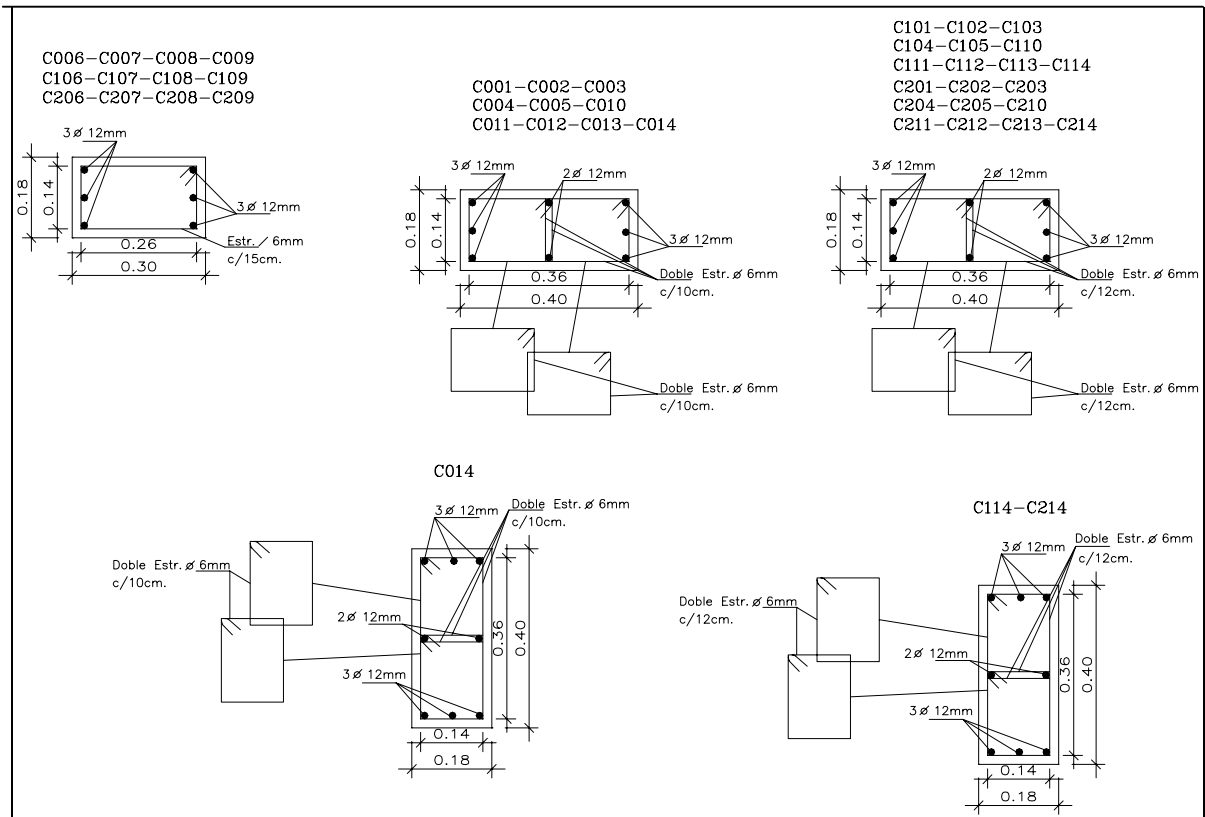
Detalle de disposición de armaduras en columnas de hormigón armado.
